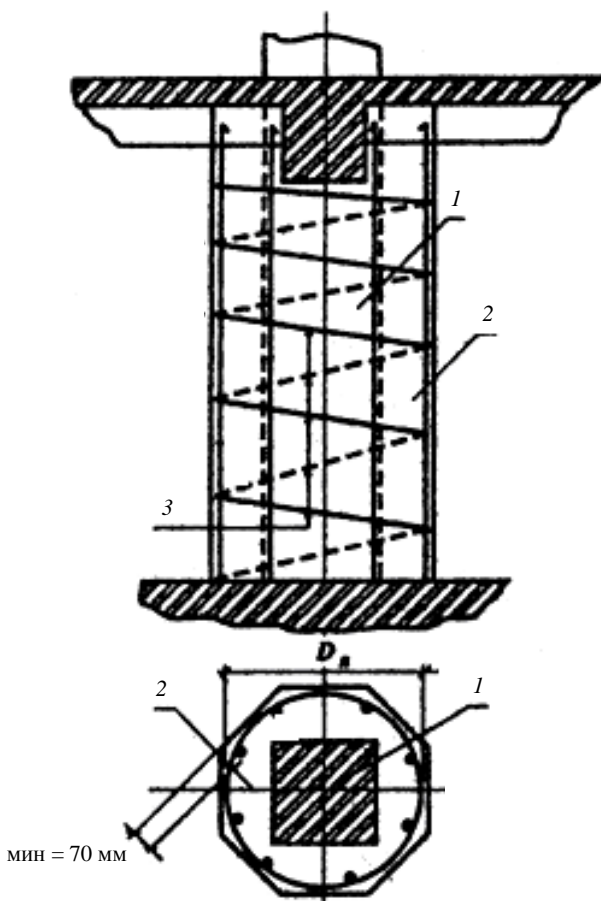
Усиление колонны железобетонной обоймой со спиральной арматурой:
